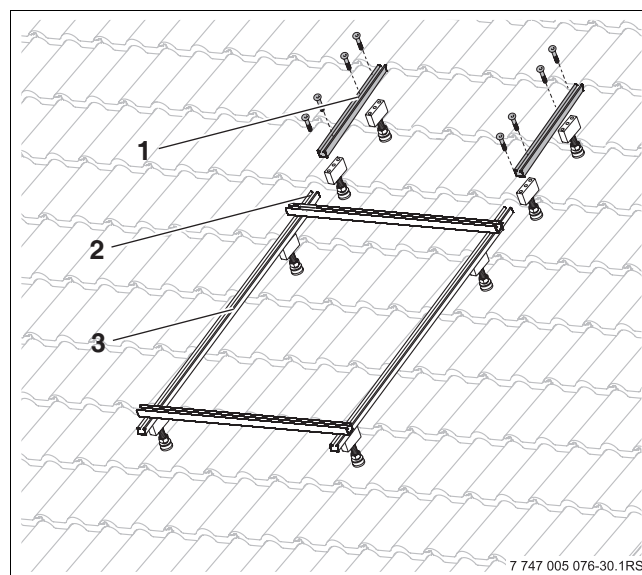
Fijar el perfil del acumulador al perfil de cubierta plana/tejado inclinado
